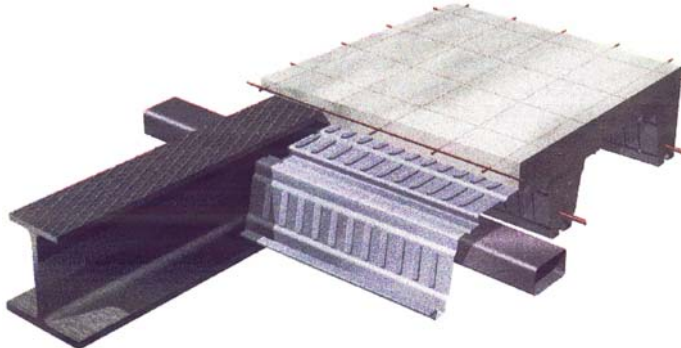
Verbunddecke mit hohen Trapezprofilblechen nach [Däuwel 2001]
